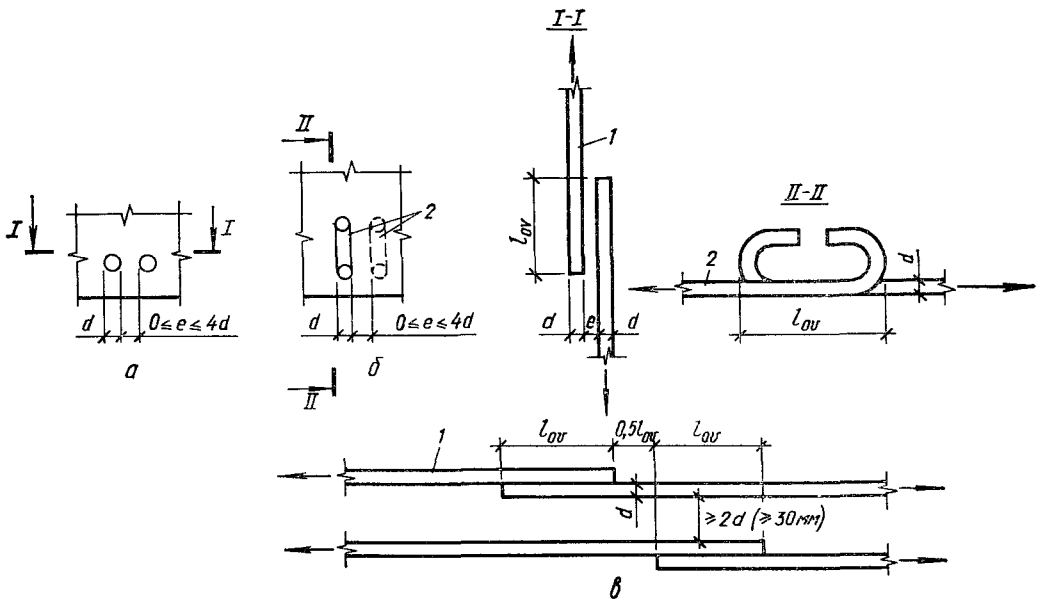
Конструирование стыков стержней продольной рабочей арматуры внахлестку (без сварки):
